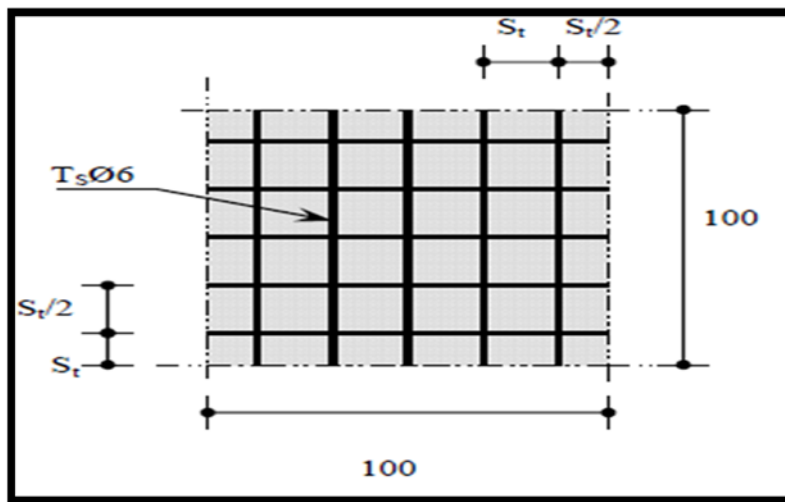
Disposition Constructive Des Armatures De La Dalle De Compression
